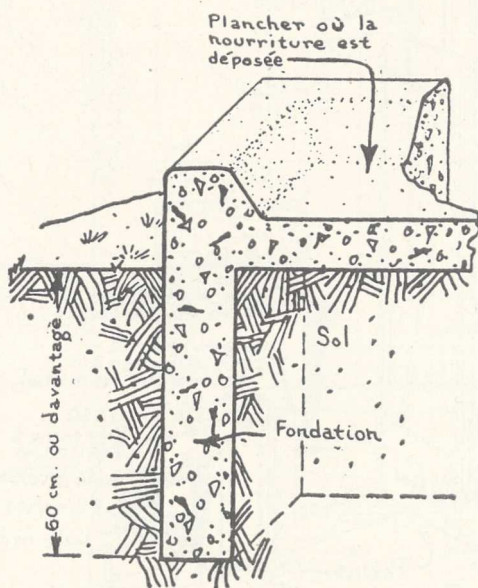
Un mur en béton construit sous un sol cimenté où la nourriture des animaux est déposée empêche la terre de s'affaisser et le plancher de se fendre. Il empêche également les rats de s'installer sous la structure.
